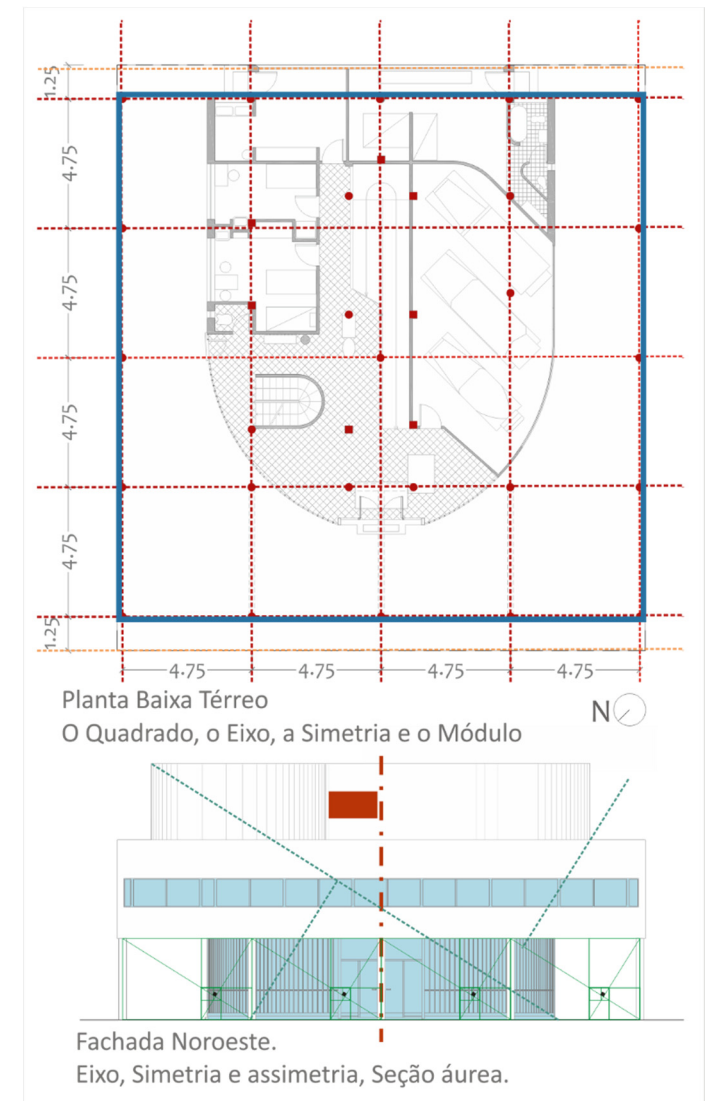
Vila Savoye, diagrama dos traçados reguladores na planta baixa do térreo e fachada de acesso. Fonte: Autora, 2017.
